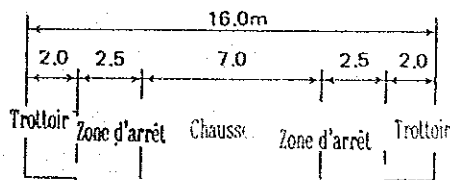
(3) Coupe transversale standard d'une route secondaire
